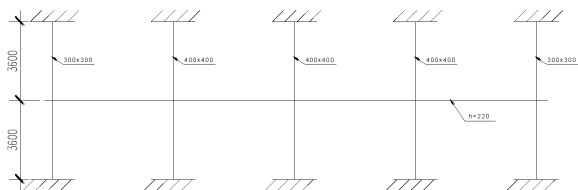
Конструкция и расчетная схема монолитного перекрытия в направлении буквенных осей
